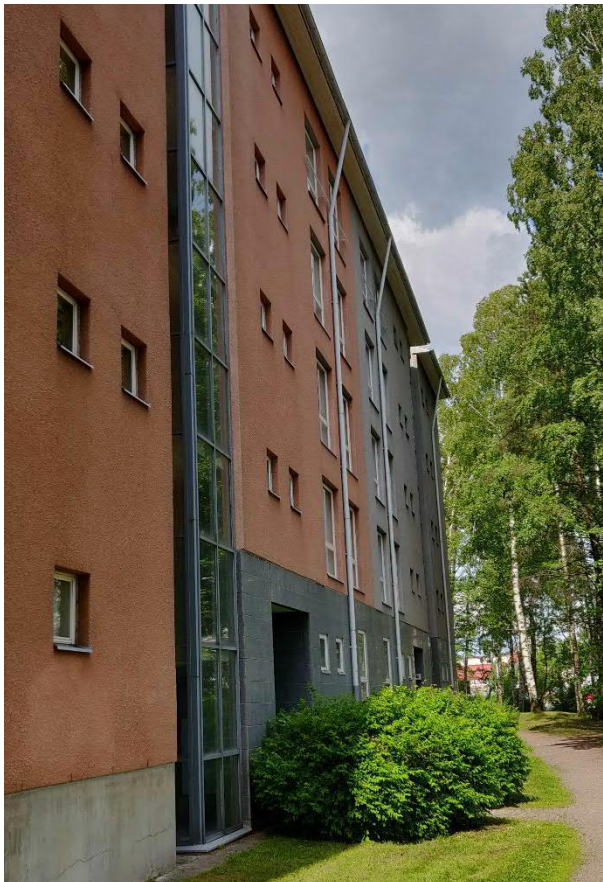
Linnanrakentajantielle oleva julkisivupinta on rapattu. Rappauksessa ei todettu rapautumista koputtelun perusteella.
